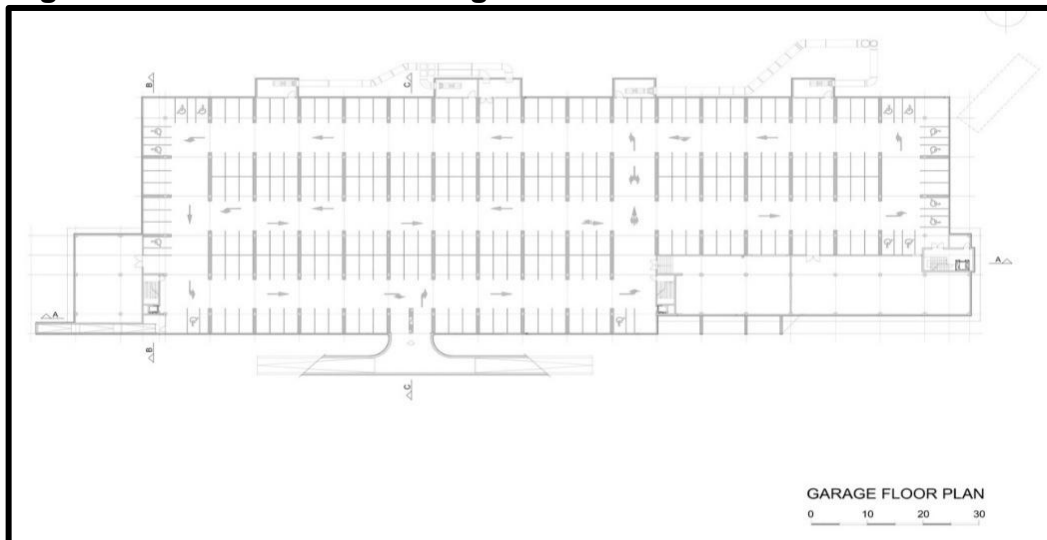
Planta Baixa – Primeiro Pavimento.
